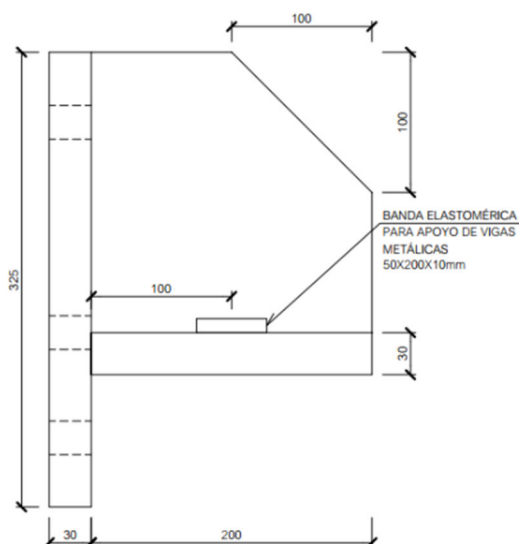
Detalle de apoyo de vigas metálicas sobre viga de hormigón armado existente
